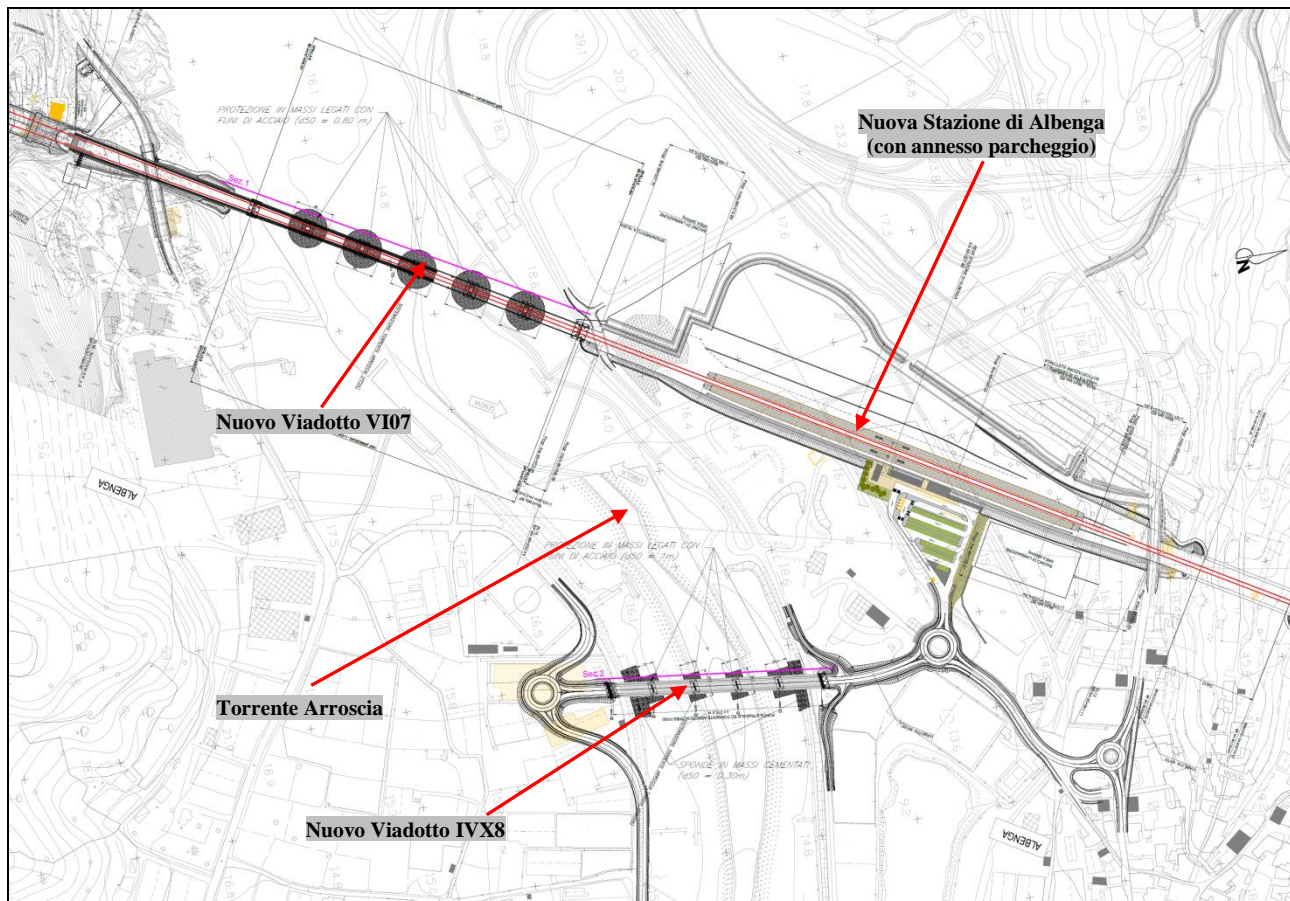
Stralcio della planimetria di progetto in quel di Albenga (attraversamento del Torrente Arroscia)
